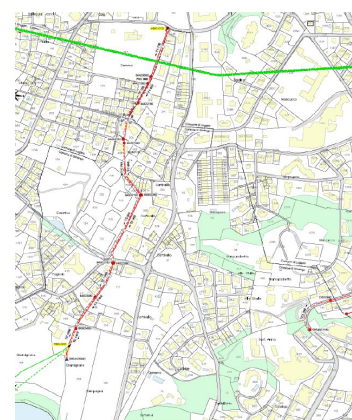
estratto piano 4547.M.d042b - Piano di dettaglio rete funzionale Sorengo
